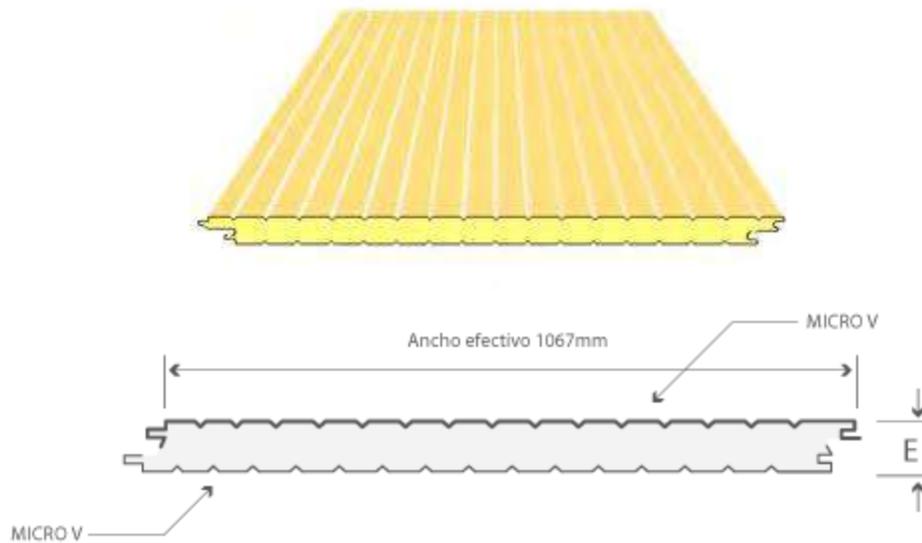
de aislante para muro de perfiles ligeros<sup>25</sup>
